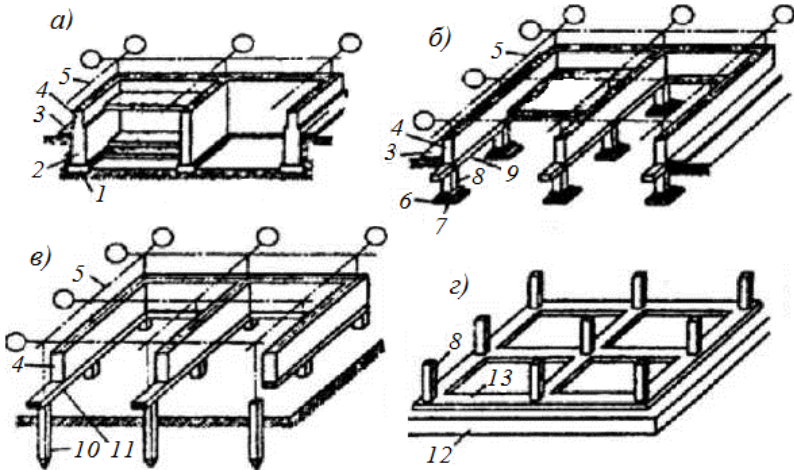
Основні типи фундаментів: *а* – стрічковий; *б* – стовпчастий; *в* – пальовий; *г* – плитний; 1 – подушка стрічкового фундаменту; 2 – стінка фундаменту; 3 – мощення; 4 – стіни будівлі; 5 – координаційні осі; 6 – подушка стовпчастого фундаменту; 7 – підколонник; 8 – стовп; 9 – фундаментна балка; 10 – палі; 11 – ростверк; 12 – суцільна плита; 13 – ребра плити
